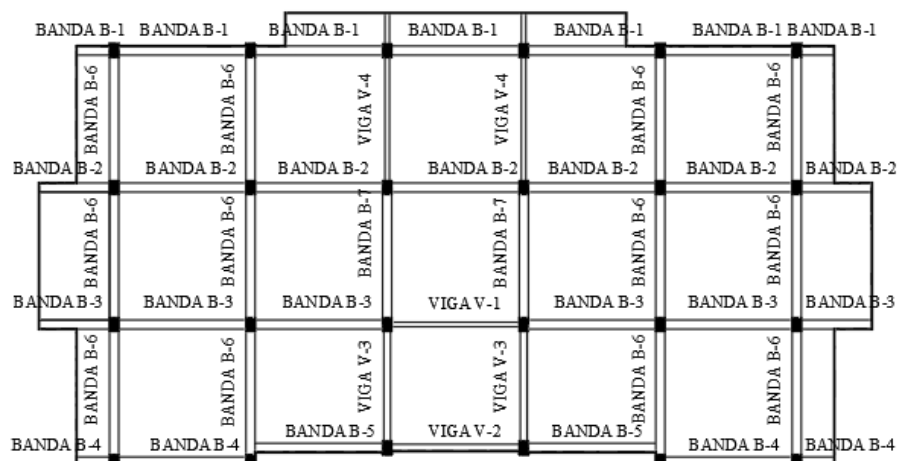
Detalle de ubicación de vigas y vigas banda en nivel 1-3
